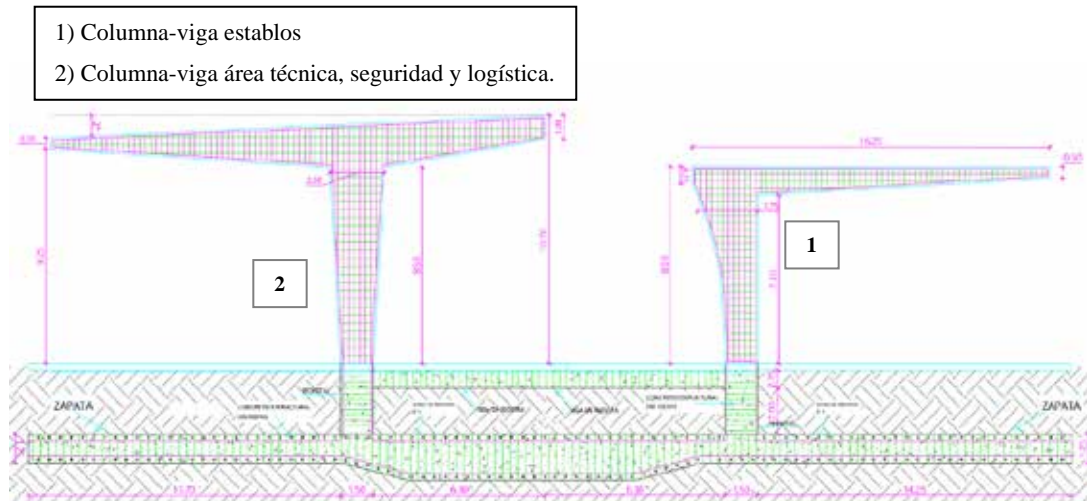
Detalle estructural de columnas-viga. La Autora (2020)
